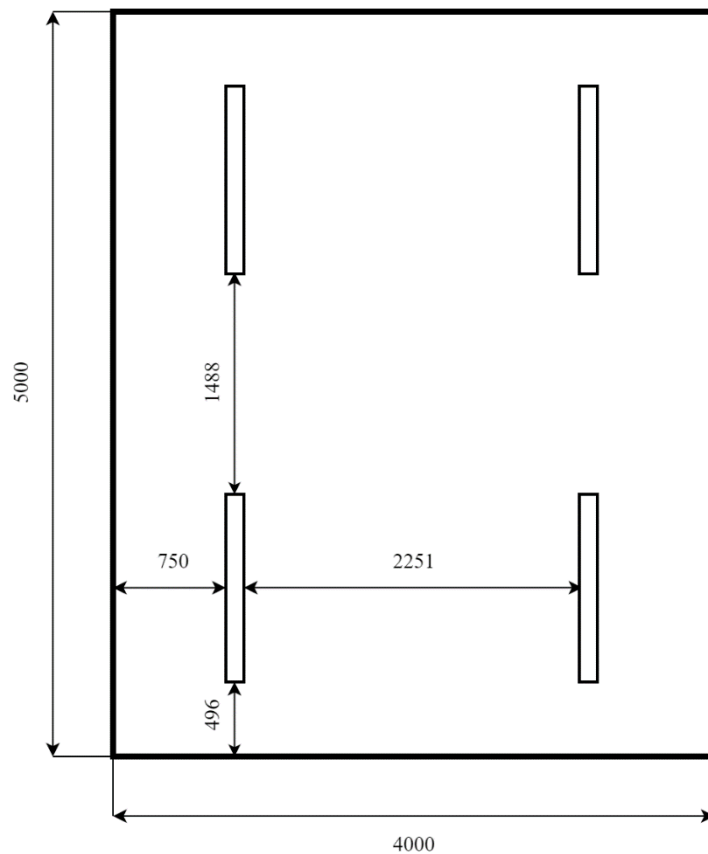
План помещения и размещения светильников со светодиодными лентами
